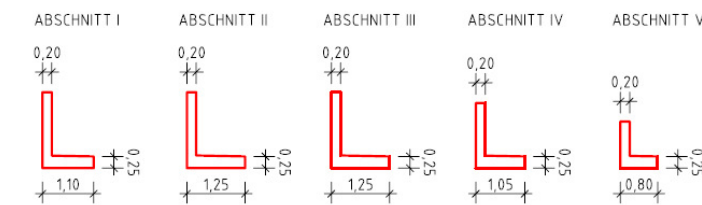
Detail Stützmauer der privaten Verkehrsfläche – Aufsicht und Ansicht
